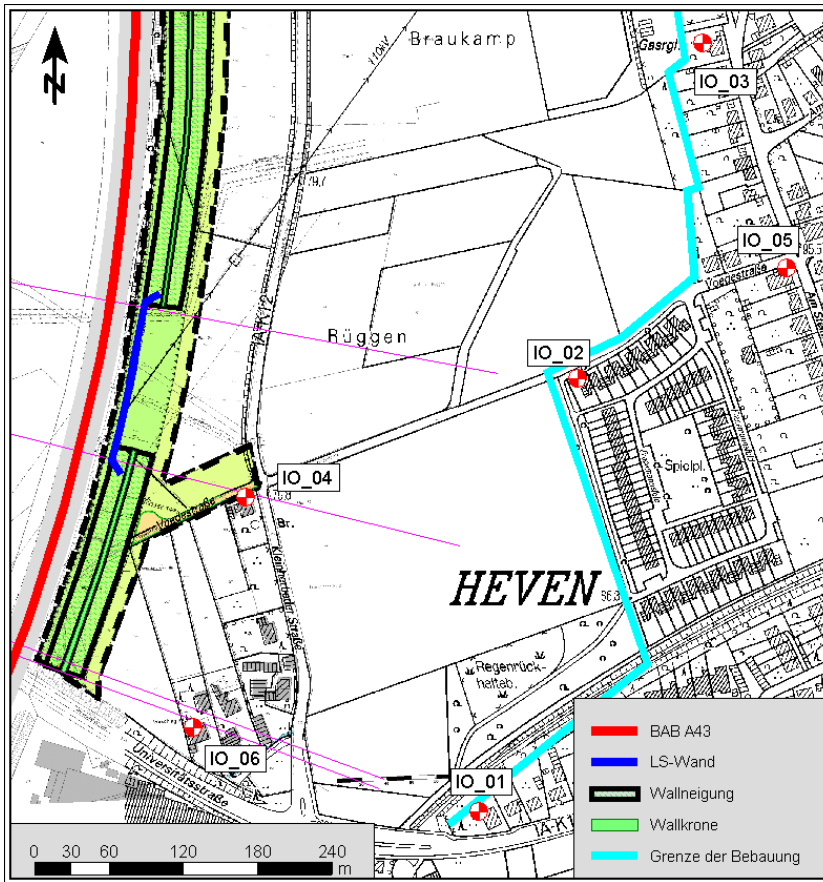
Lageplan mit verlängertem Wall und Immissionsaufpunkten
